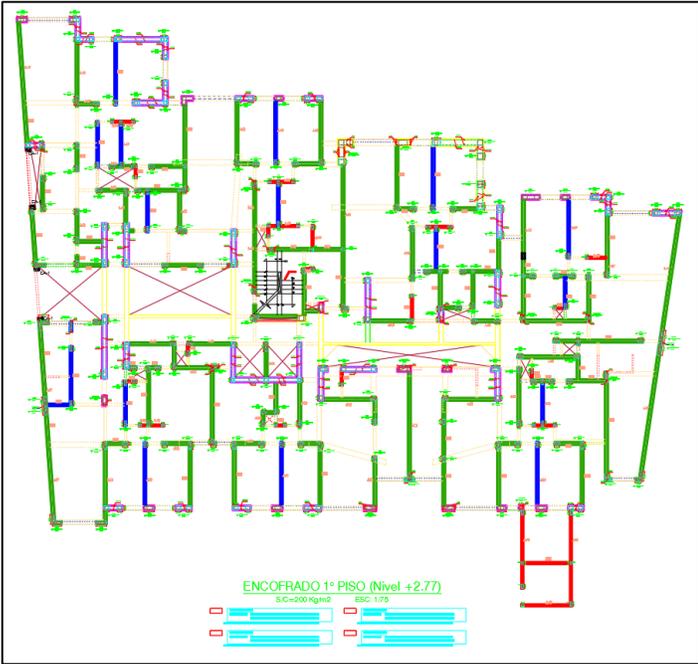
Plano de muros. Fuente: Elaboración Propia
